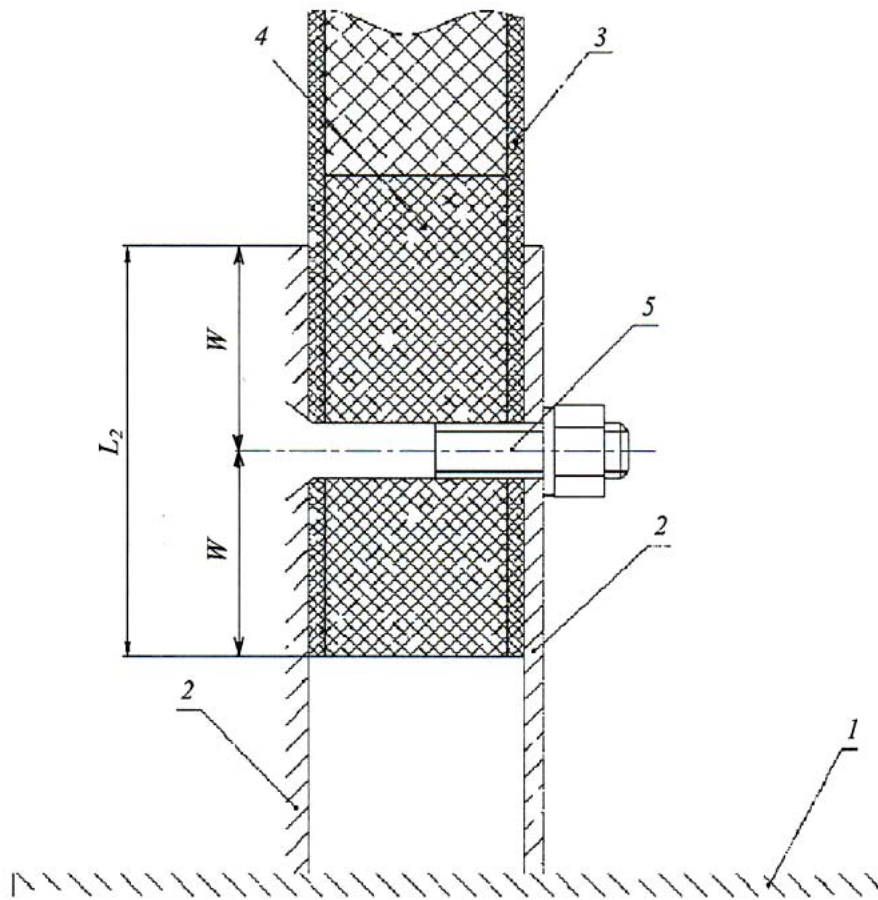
Вузол клеєболтового з'єднання перегородки з металевим корпусом
